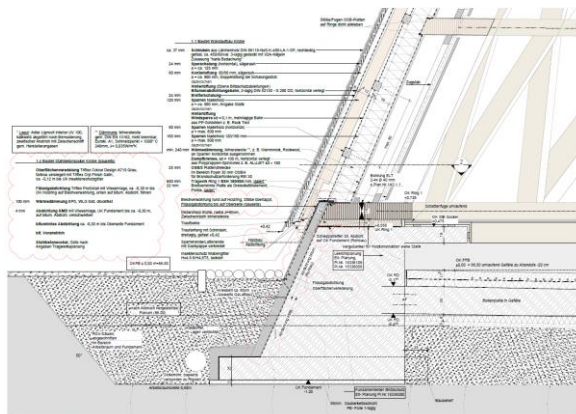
Planausschnitt Büro Wimmer 1A3.5.1a
